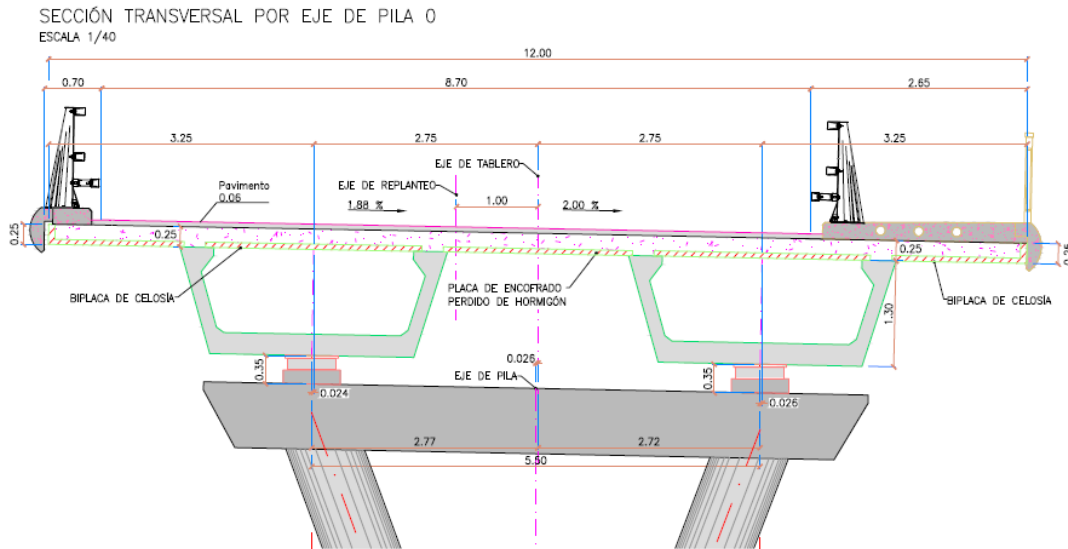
Tablero de vigas prefabricadas hiperestáticas.
